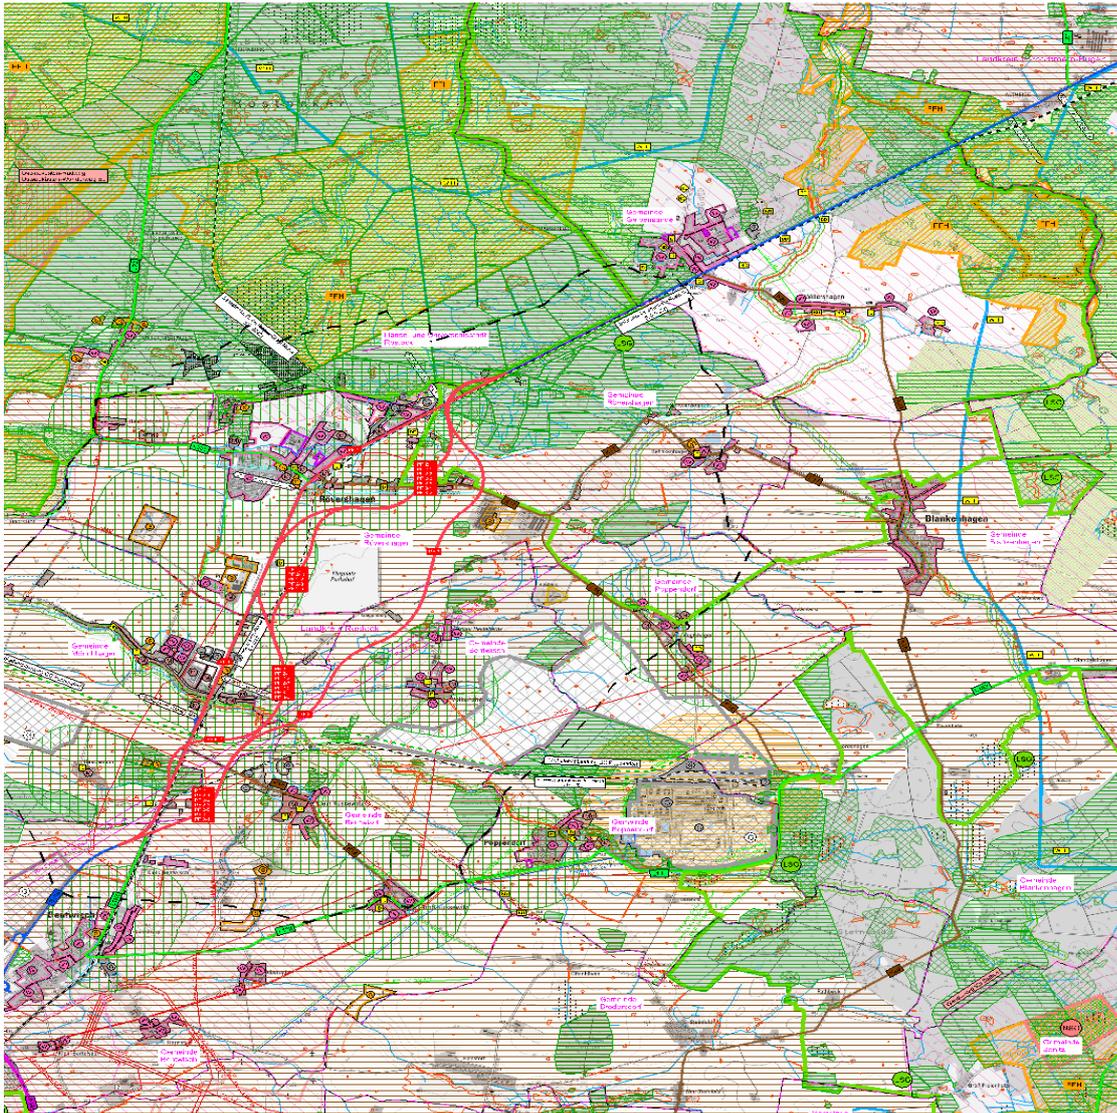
Übersichtslageplan der Planfälle (Quelle: Voruntersuchung zur B 105 OU Mönchhagen/Rövershagen)
